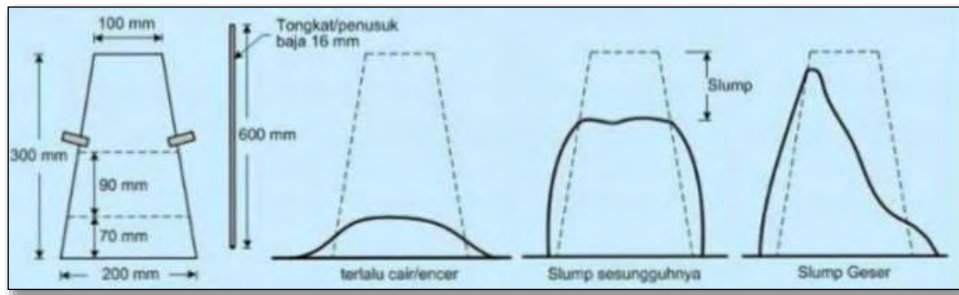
Campuran Adukan Beton kelebihan Air
